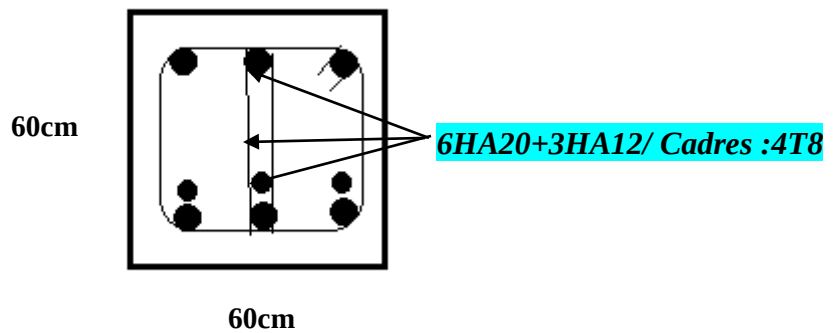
Schéma de ferrailage de longrine 60×60.
